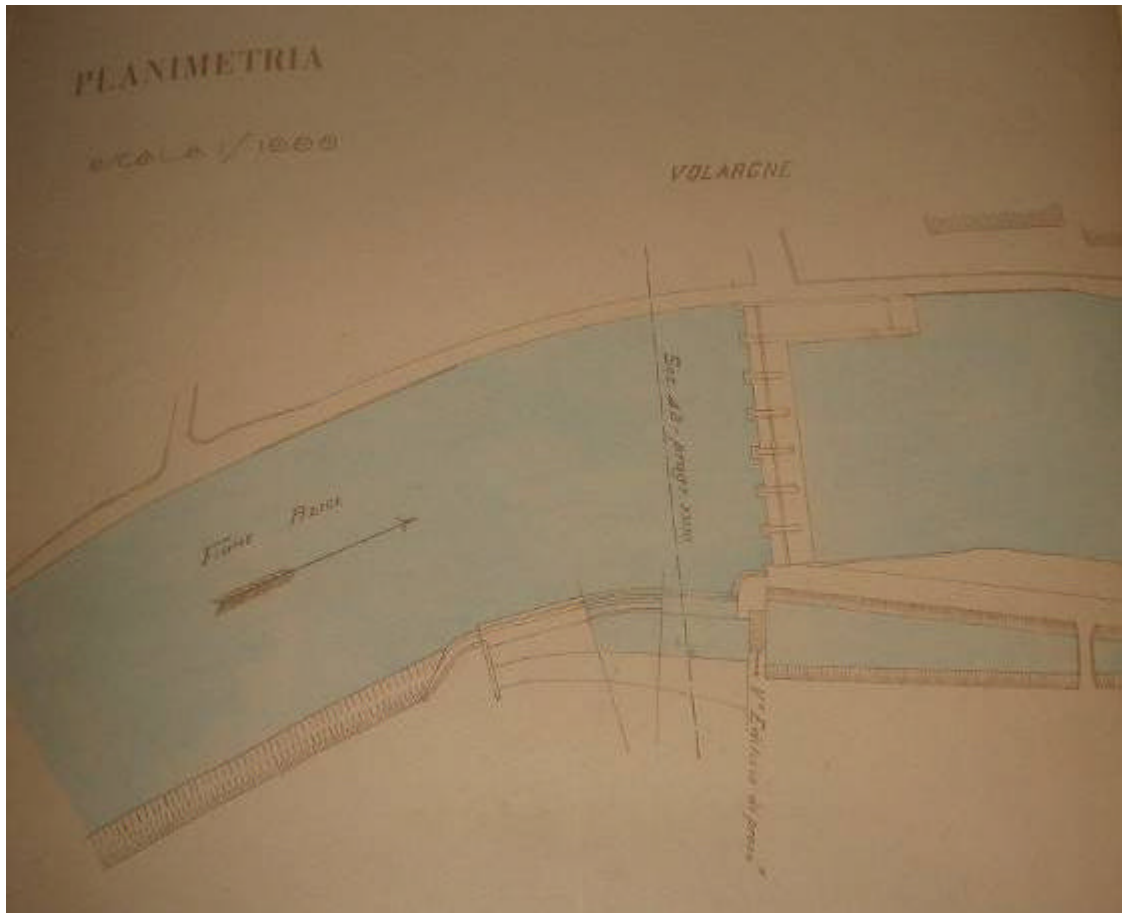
Planimetria della presa a Volargne (G.Rubinelli,1924).
